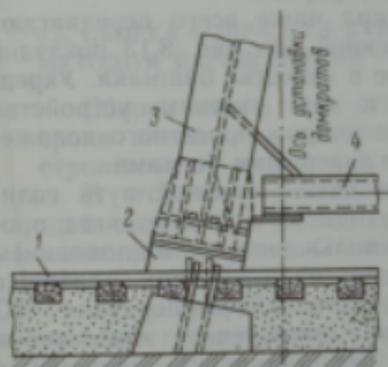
Конструкция опорного башмака, закрепленного на ноге копра: 1 — направляющие; 2 — опорный башмак; 3 — нога станка копра; 4 — усиление копра
